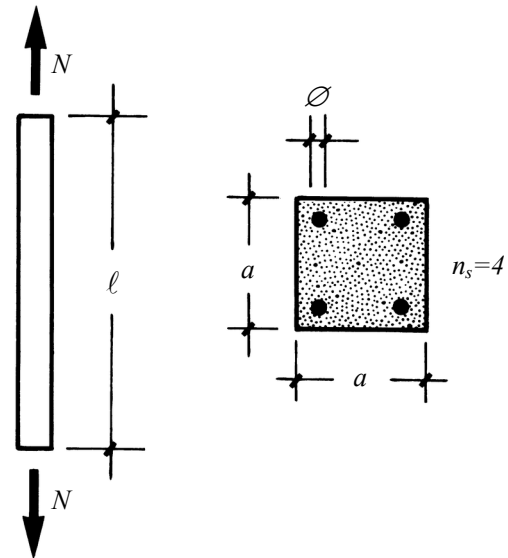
Vereinfachtes Modell eines Stahlbetonzuggliedes
